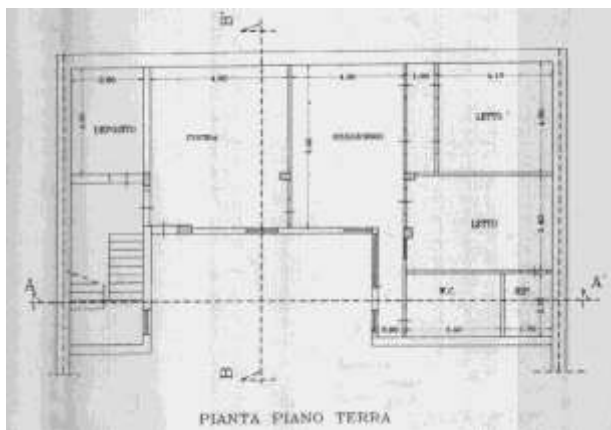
planimetria appartamento al piano terra come da concessione edilizia in sanatoria n. 294 del 11/11/1999 ed istanza di condono prot. n. 6187 del 25/09/1986
